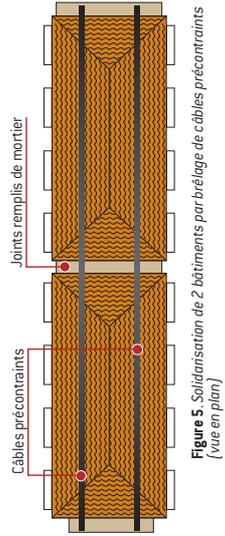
Solidarisation de 2 bâtiments par brélage de câbles précontraints (vue en plan)
